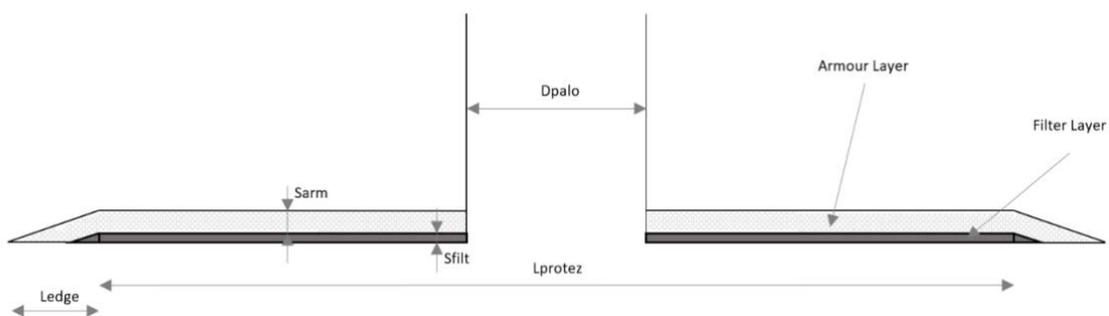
Disposizione caratteristica della protezione dell'area di fondazione
